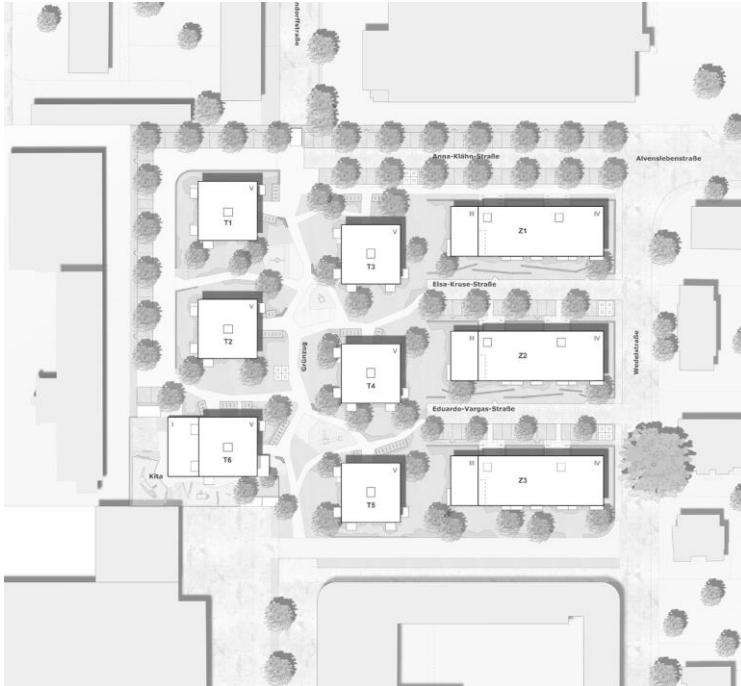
Lageplan (Freiraum: GrünPlan, Hannover)
